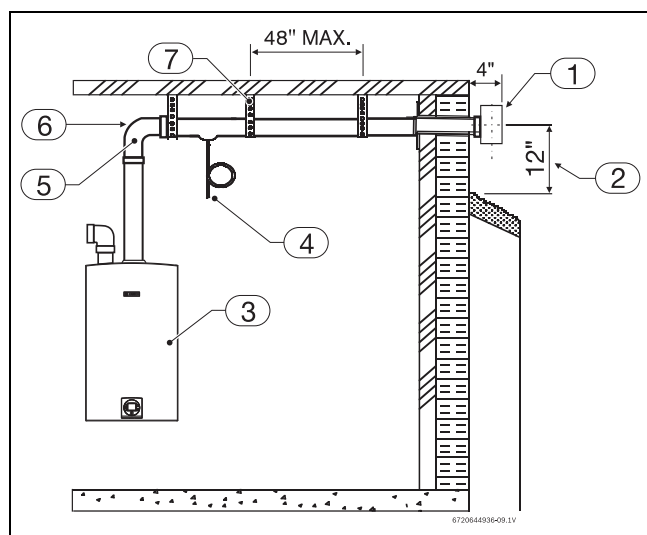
Installation de ventilation horizontale sur mur latéral (pénétration de tuyau simple)
